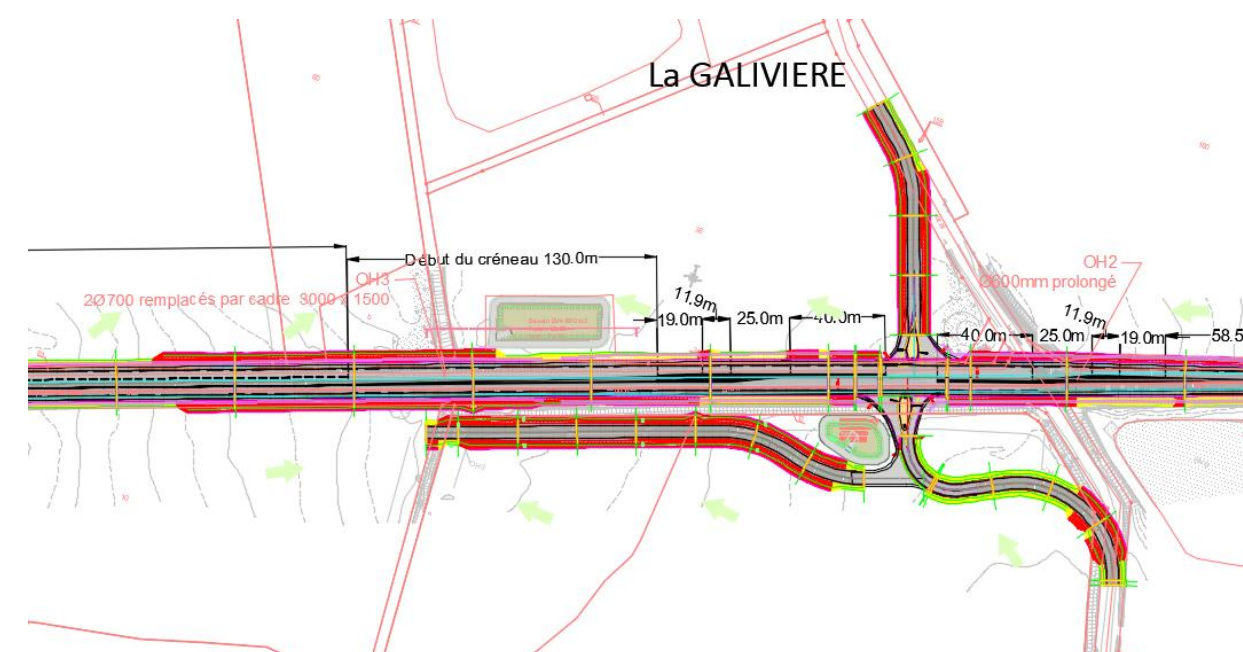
Plan du carrefour d'extrémité Est Section 1
